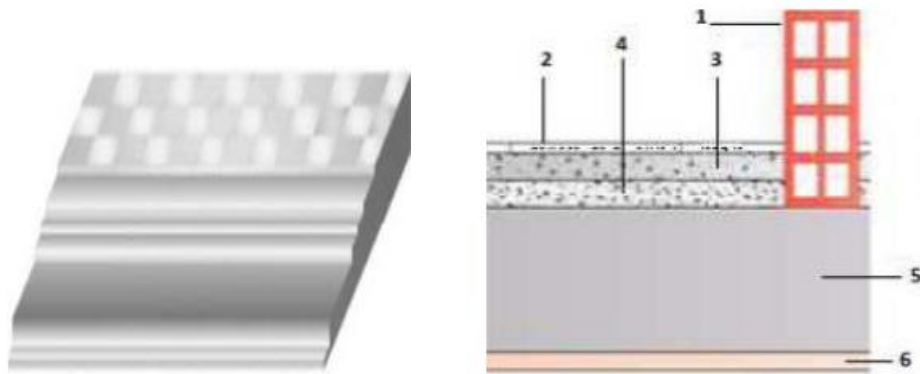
Coupe verticale d'un plancher en dalle pleine de niveau courant
